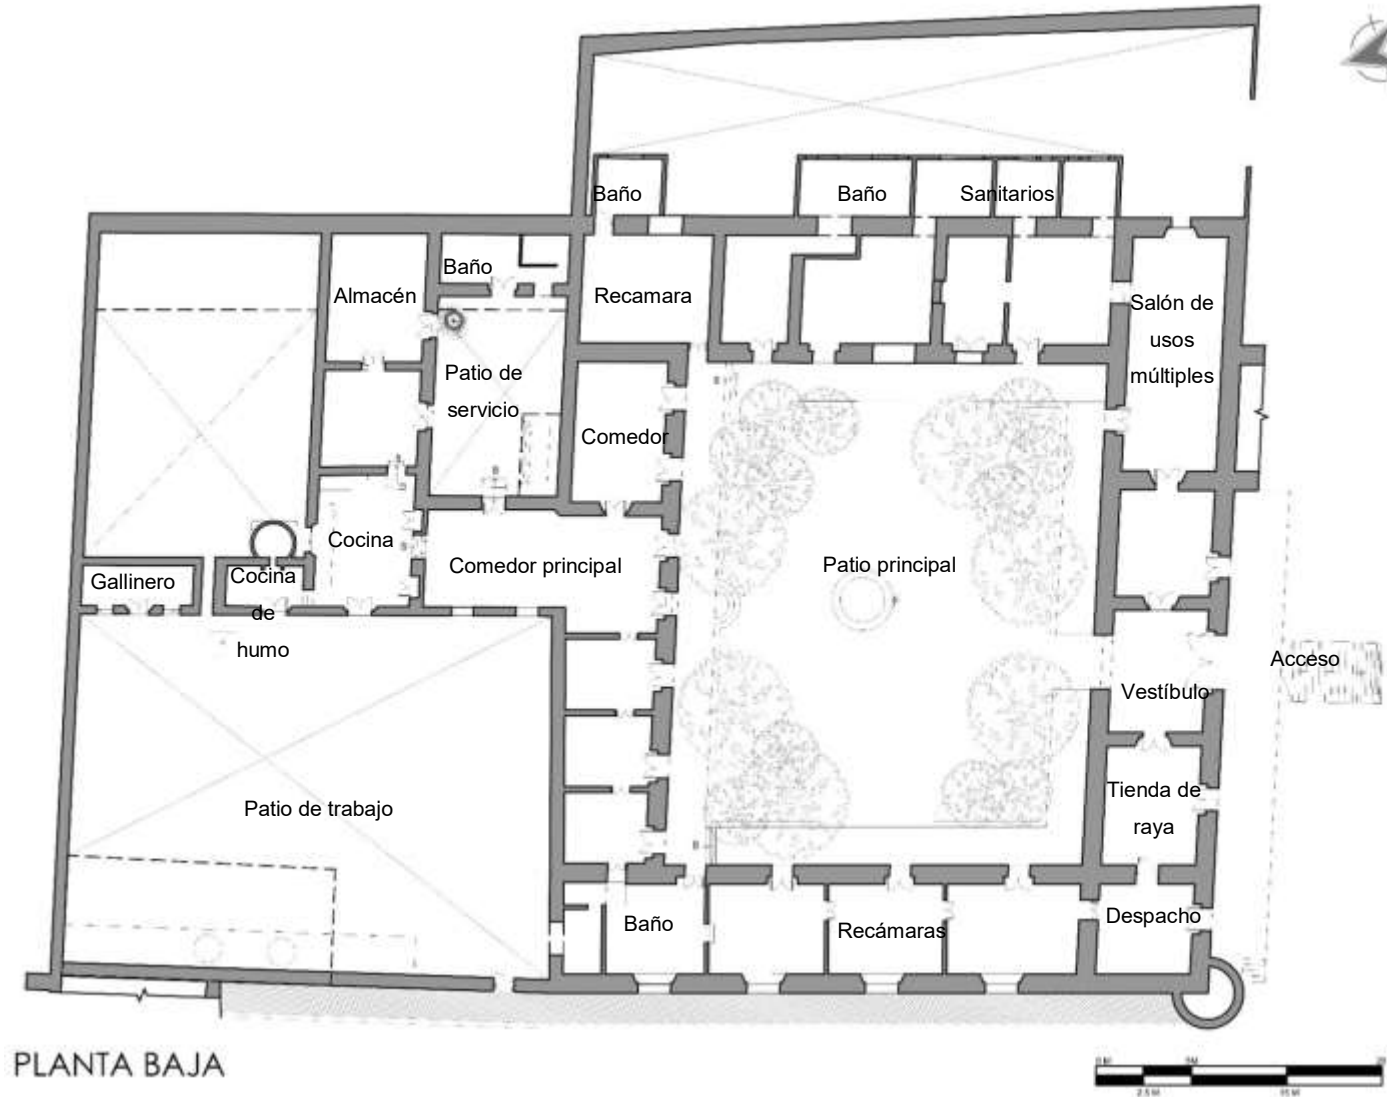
Plano de la Planta Baja de la Casa del Hacendado.
